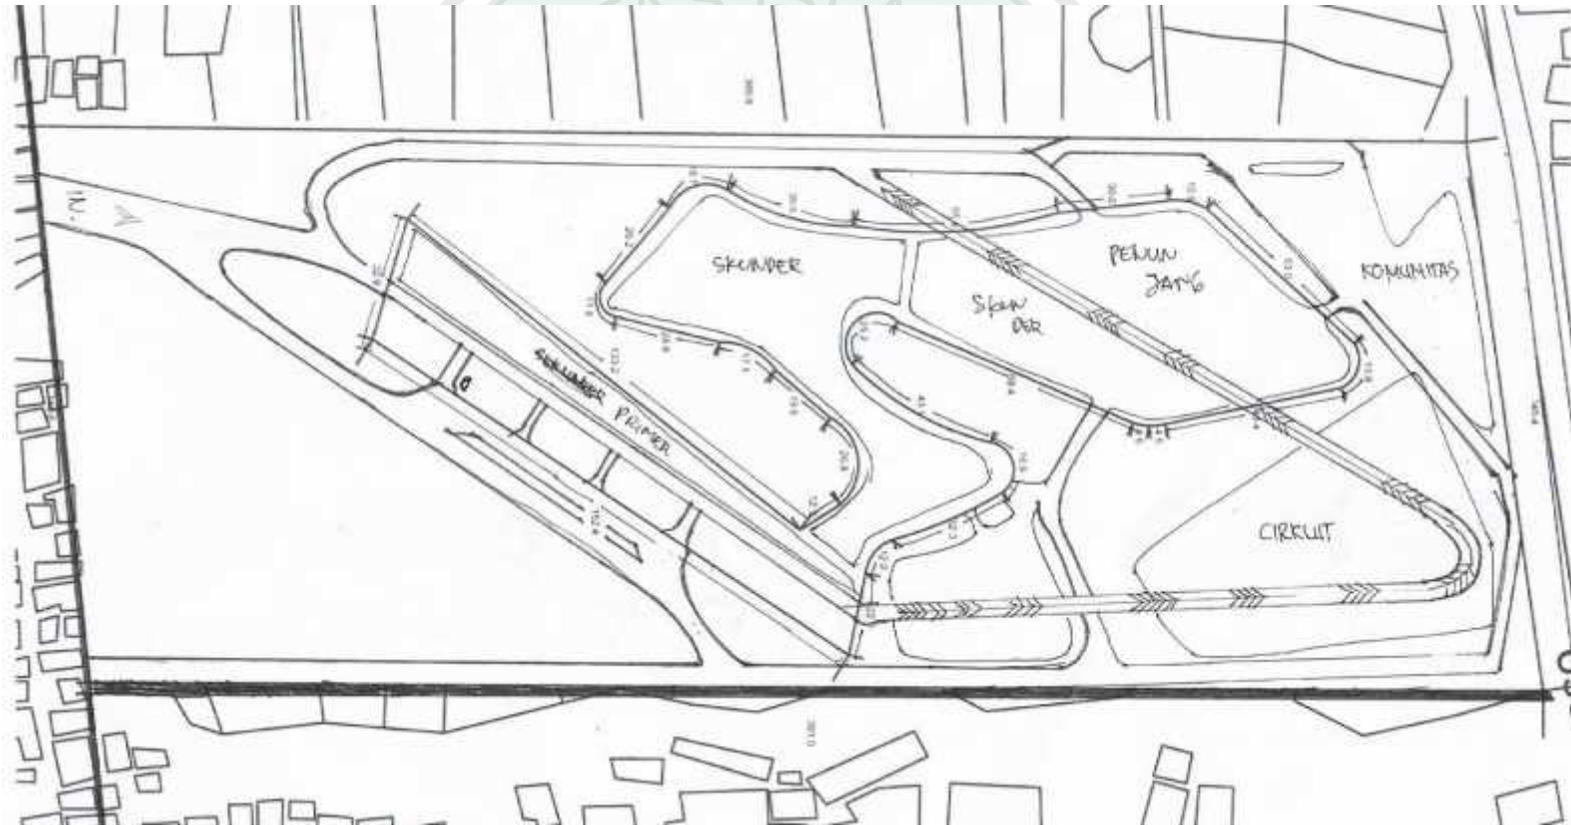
Alternatif blockplan zoning ruang ke 1 (Sumber: Analisis pribadi, 2014)
